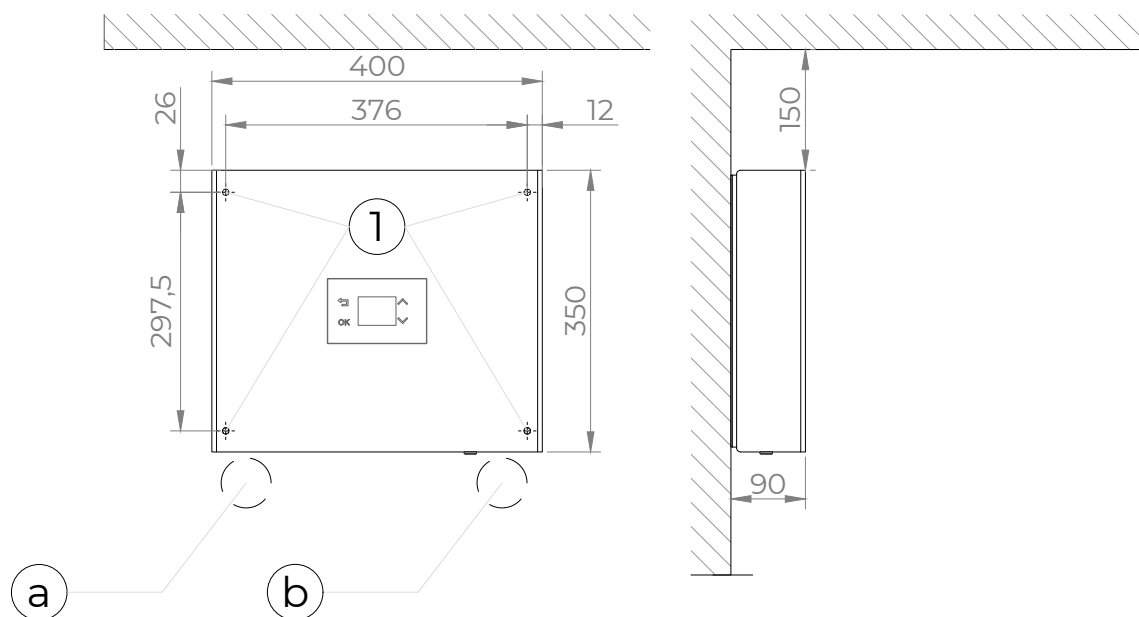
Bijlage 7 - Plan voor de installatie van de HYDRO C2 + ZA_P40
